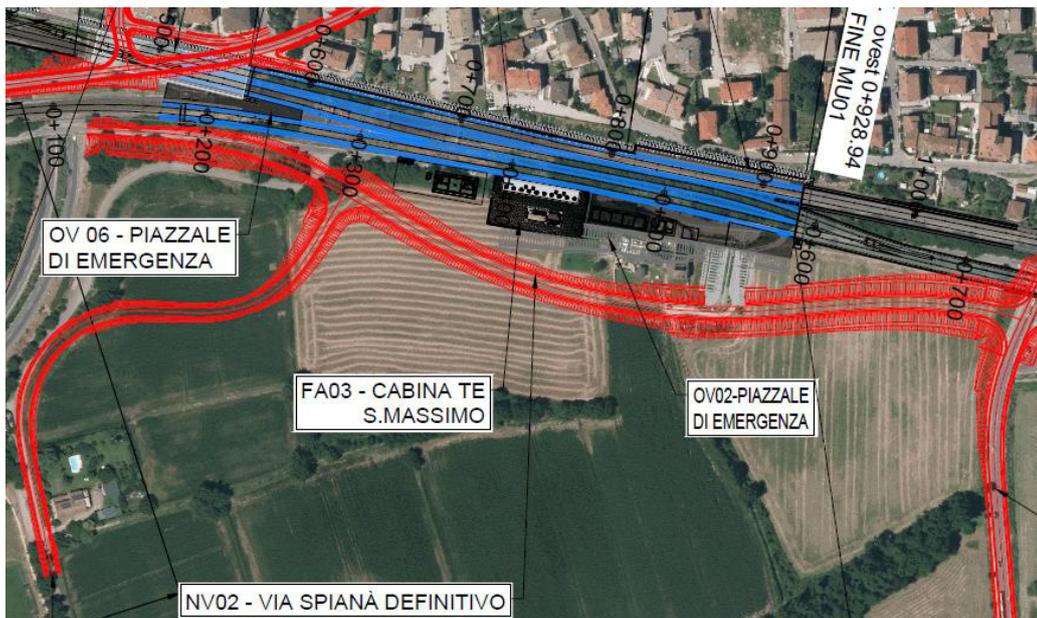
NV02, NV02.1 – Stralcio planimetrico su ortofoto degli interventi su Via della Spianà e Via Sogare
